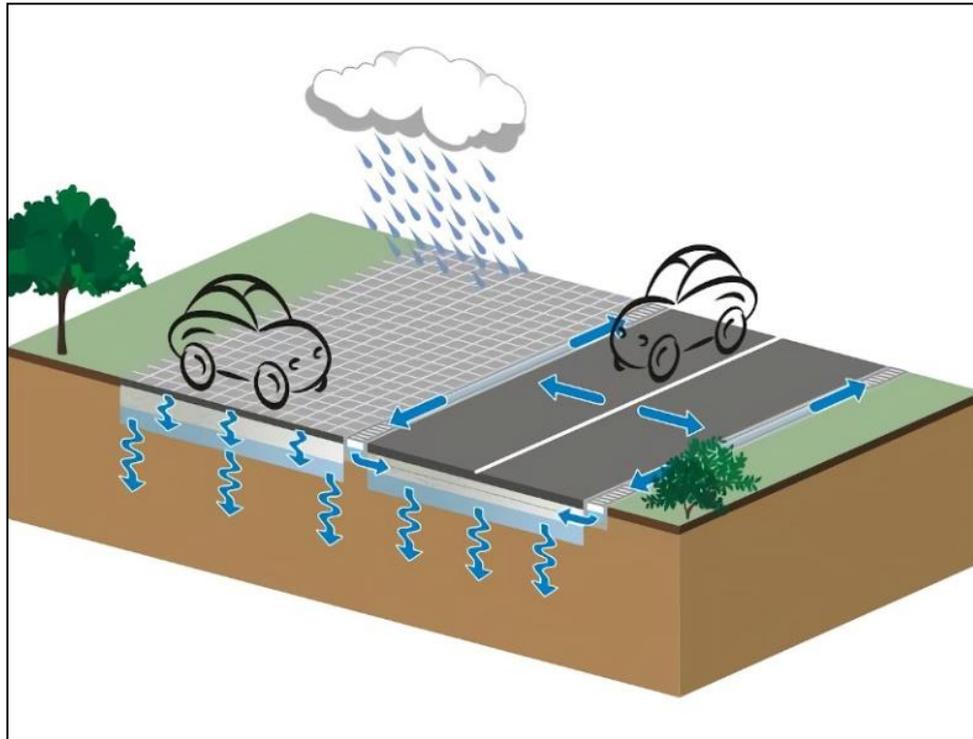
Chaussée à structure réservoir, Craponne, (guidebatimentdurable, 2019).
